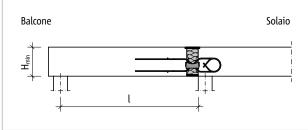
Schöck Isokorb® T tipo QL-V1: sistema statico
